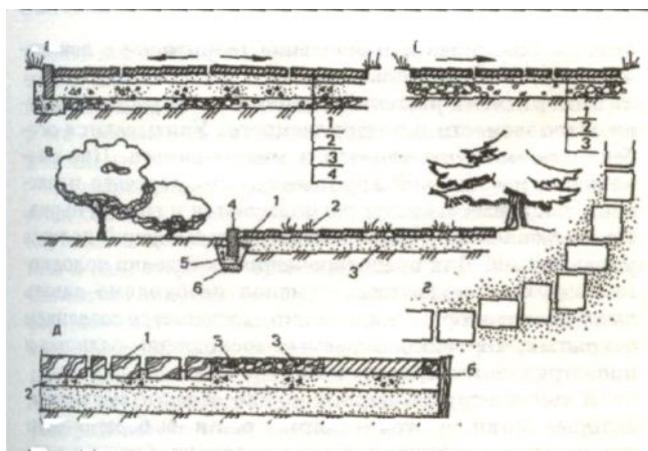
Конструкции парковых аллей и дорожек: а - транзитная дорога (1 - плиты бетонные, 6 см; 2 - выравнивающий слой цементного раствора, 3 см; 3 - бетон, 10 см; 4 - щебень или шлак, 5-10 см); б - садовая пешеходная аллея (! - плиты бетонные, 4~6 см; 2 - выравнивающий слой, 2~3 см; 3 - щебень, 3 см); в - дорожка на песчаном основании I! ~ обломы плит; 2 - растительный грунт; 3 - песок, III см); г - укладка плит на углах и поворотах; д - дорога с комбинированным покрытием (1 - деревянные торцы, 10 см; 2 - цемент, 5 см; 3 - галька на цементном растворе; 4 - песок, 5 см; 5 - борт из деревянных чурок)
